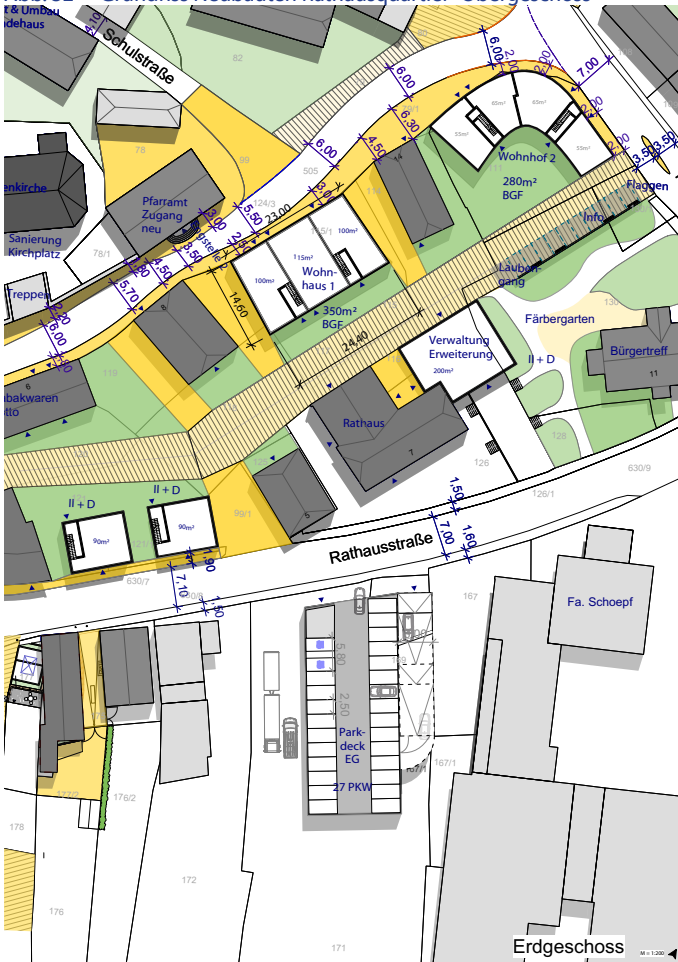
Grundriss Neubauten Rathausquartier- Erdgeschoss
